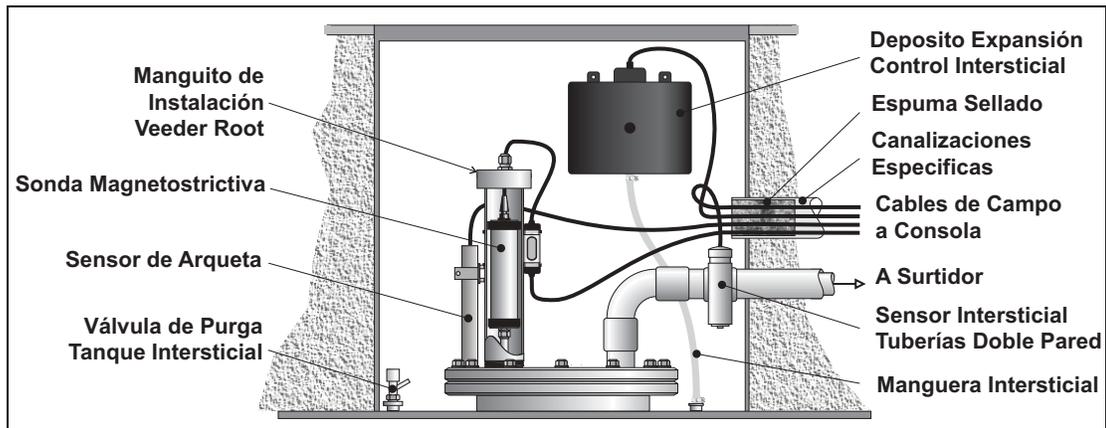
Instalación típica de la cámara de acceso a la tapa del tanque
